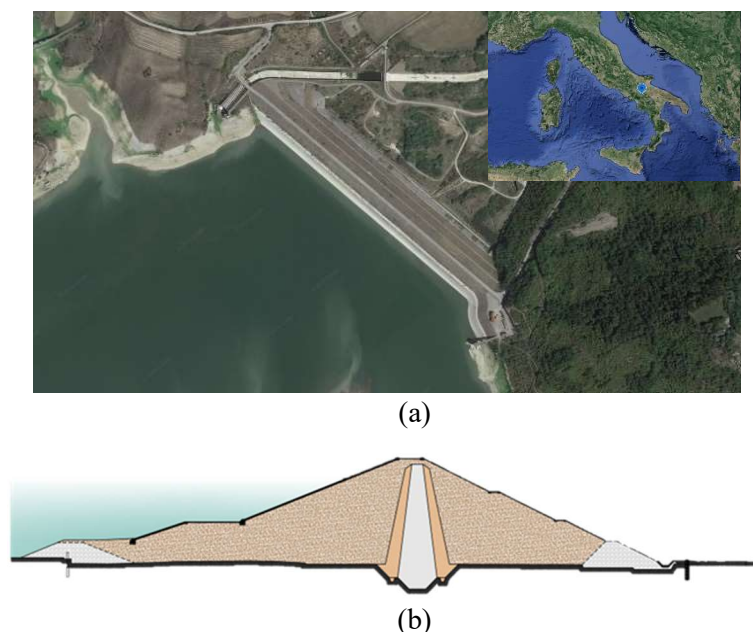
(a) Planimetria e (b) sezione maestra della diga di riferimento.
